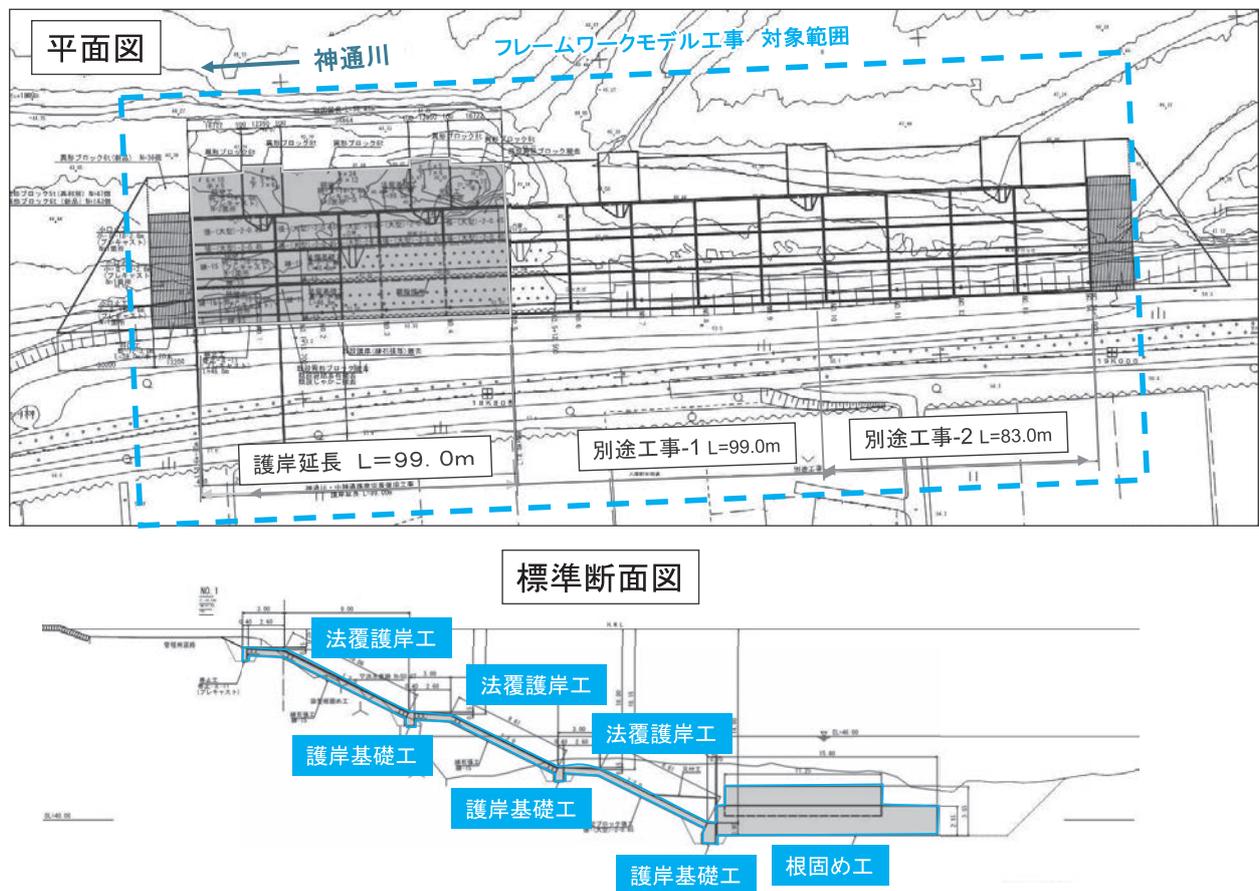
フレームワークモデル工事（試行）の平面図・標準断面図
